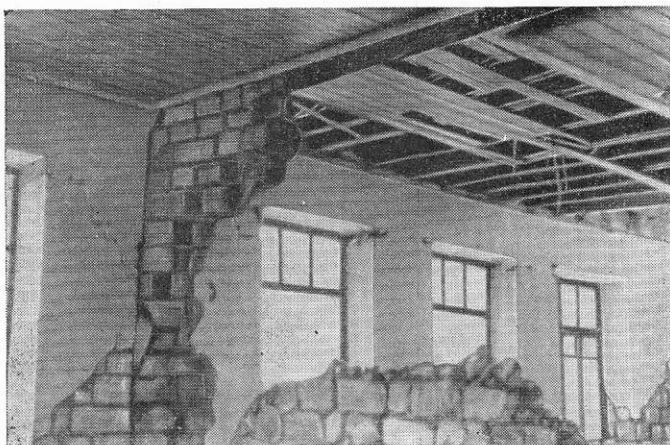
Разрушение перекрытий и внутренней поперечной стены на 2-м этаже
